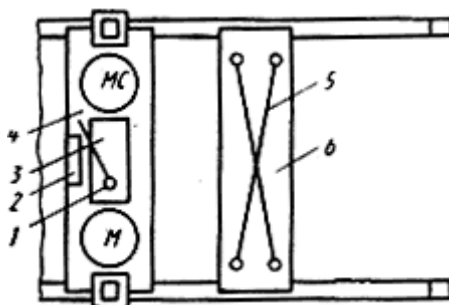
Схема организации рабочего места при монтаже панели перекрытия
